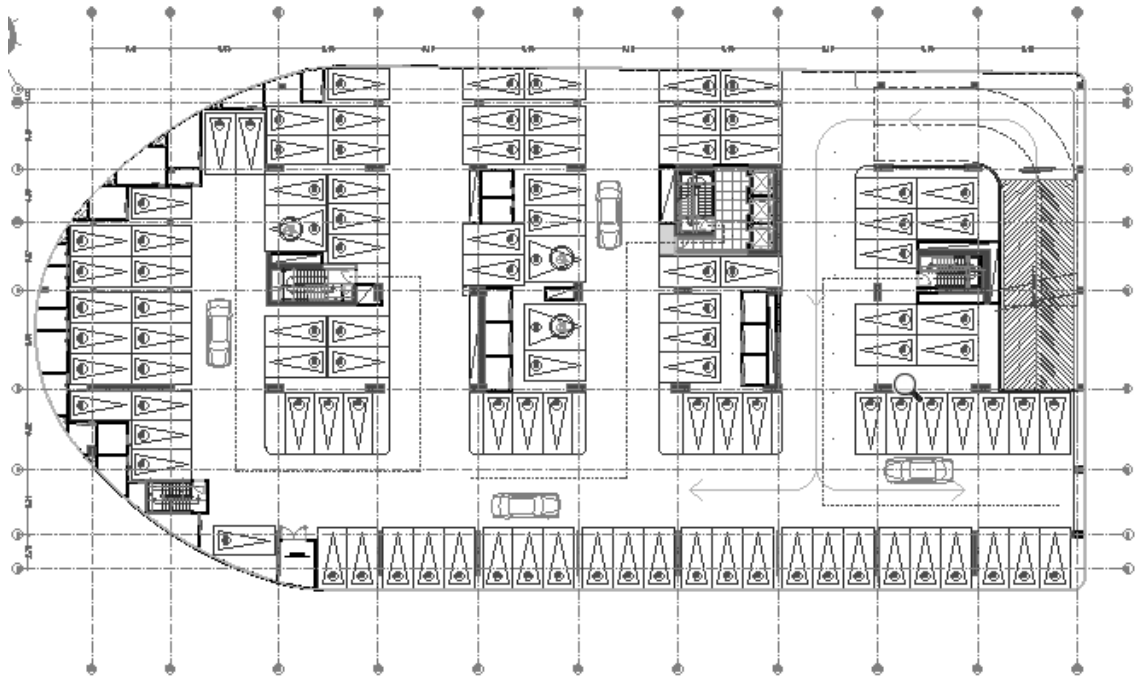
Distribución de paredes, paredes, escaleras y ascensor en piso 2 aparcamiento.
